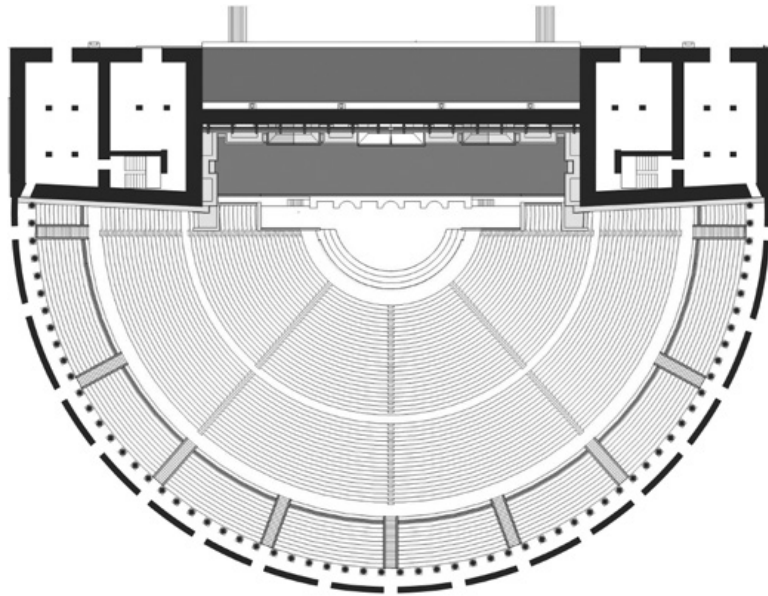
Reconstrucción del Teatro. Planta por la *summa cavea*.
